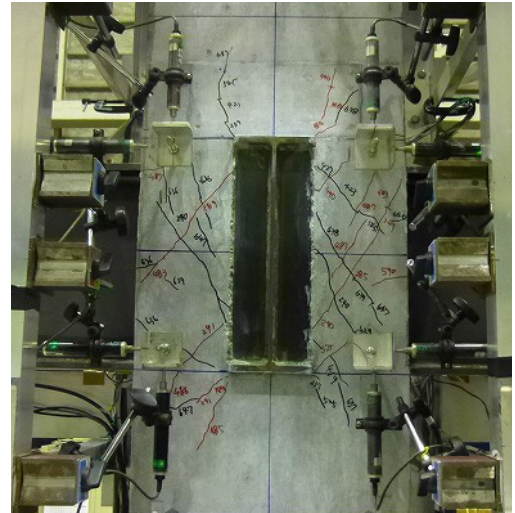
ひび割れ発生状況 (NF60:R=+20×10⁻³rad)
